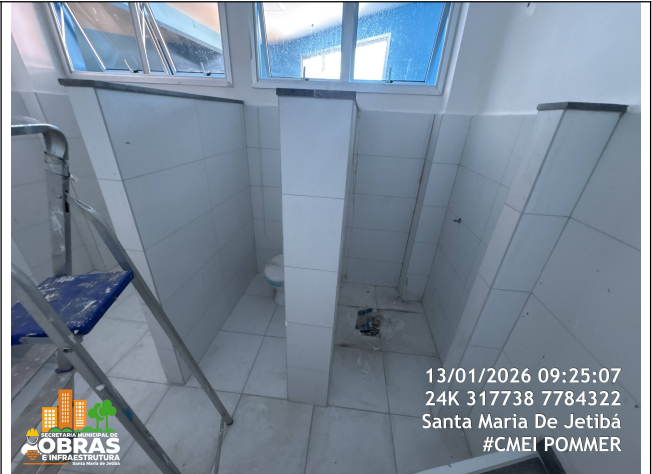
Assentamento de psio cerâmico nos banheiros do 3º pavimento
